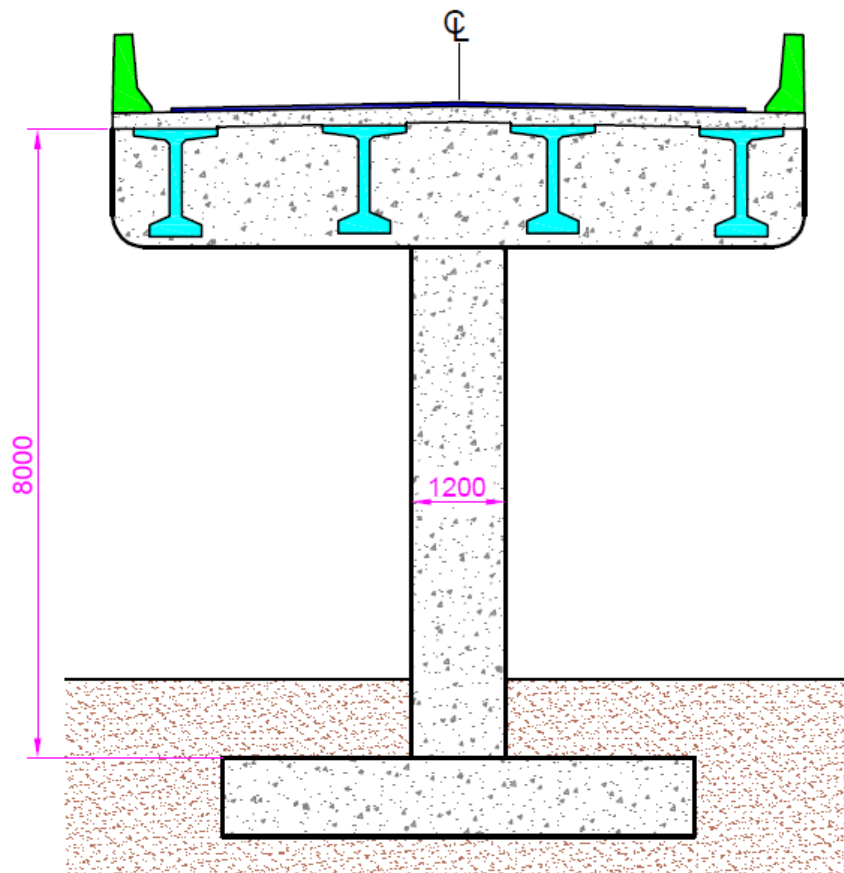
Pila típica de paso elevado – ejemplo 3.1, 3.2 y 3.3
